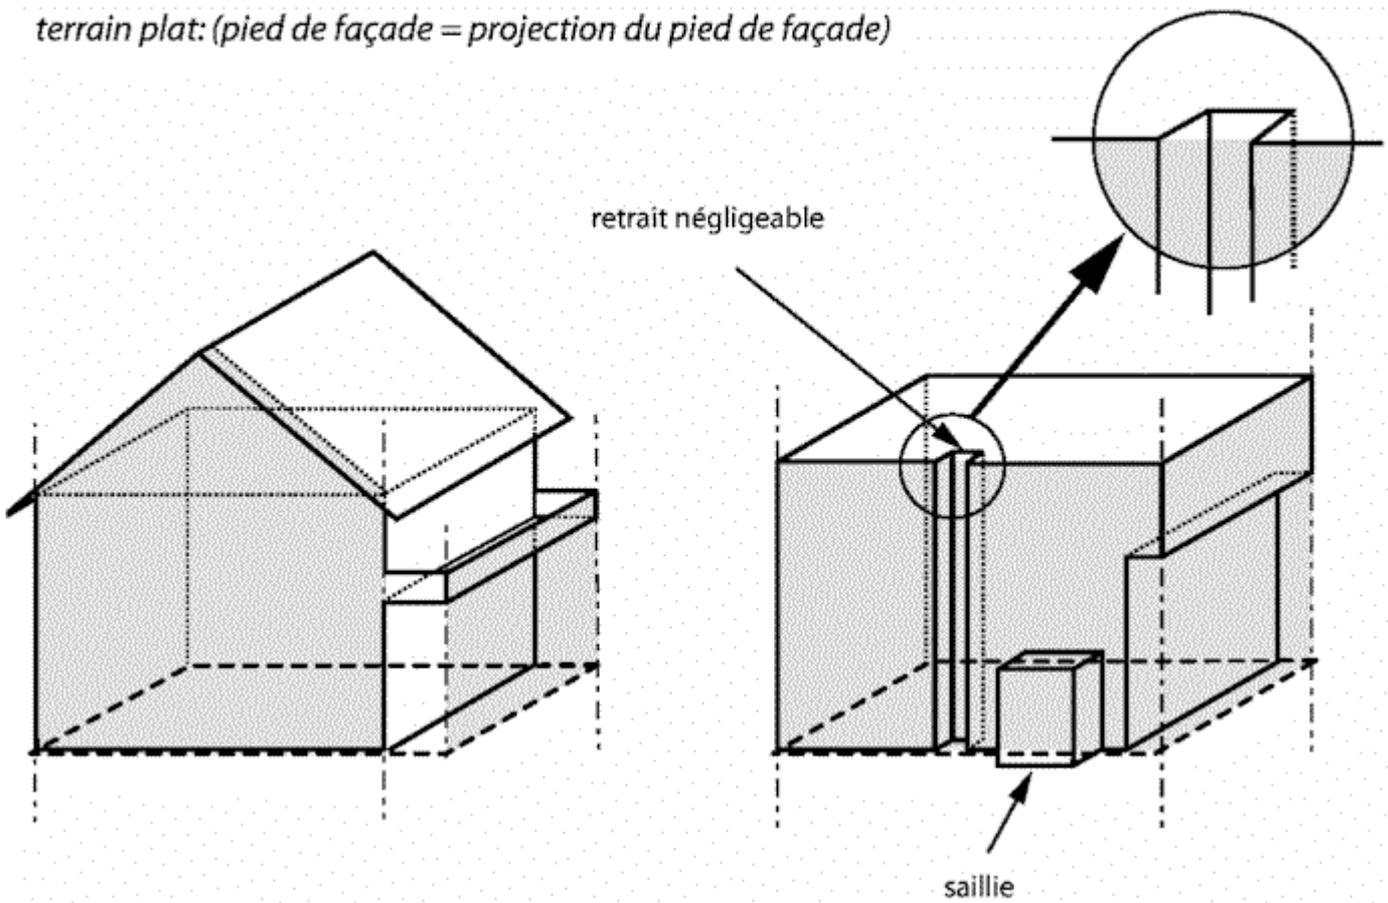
a Plan de façade et projection du pied de façade (sur terrain plat)
